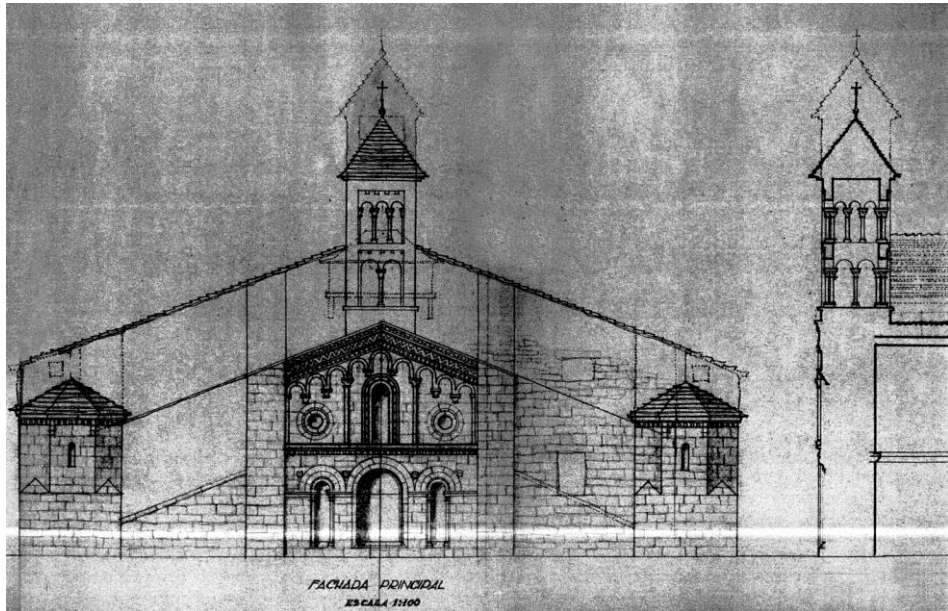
Seo de Urgel. Catedral de Santa María AAFV. Secciones y alzado del campanil. Planos de proyecto. A. Ferrant
